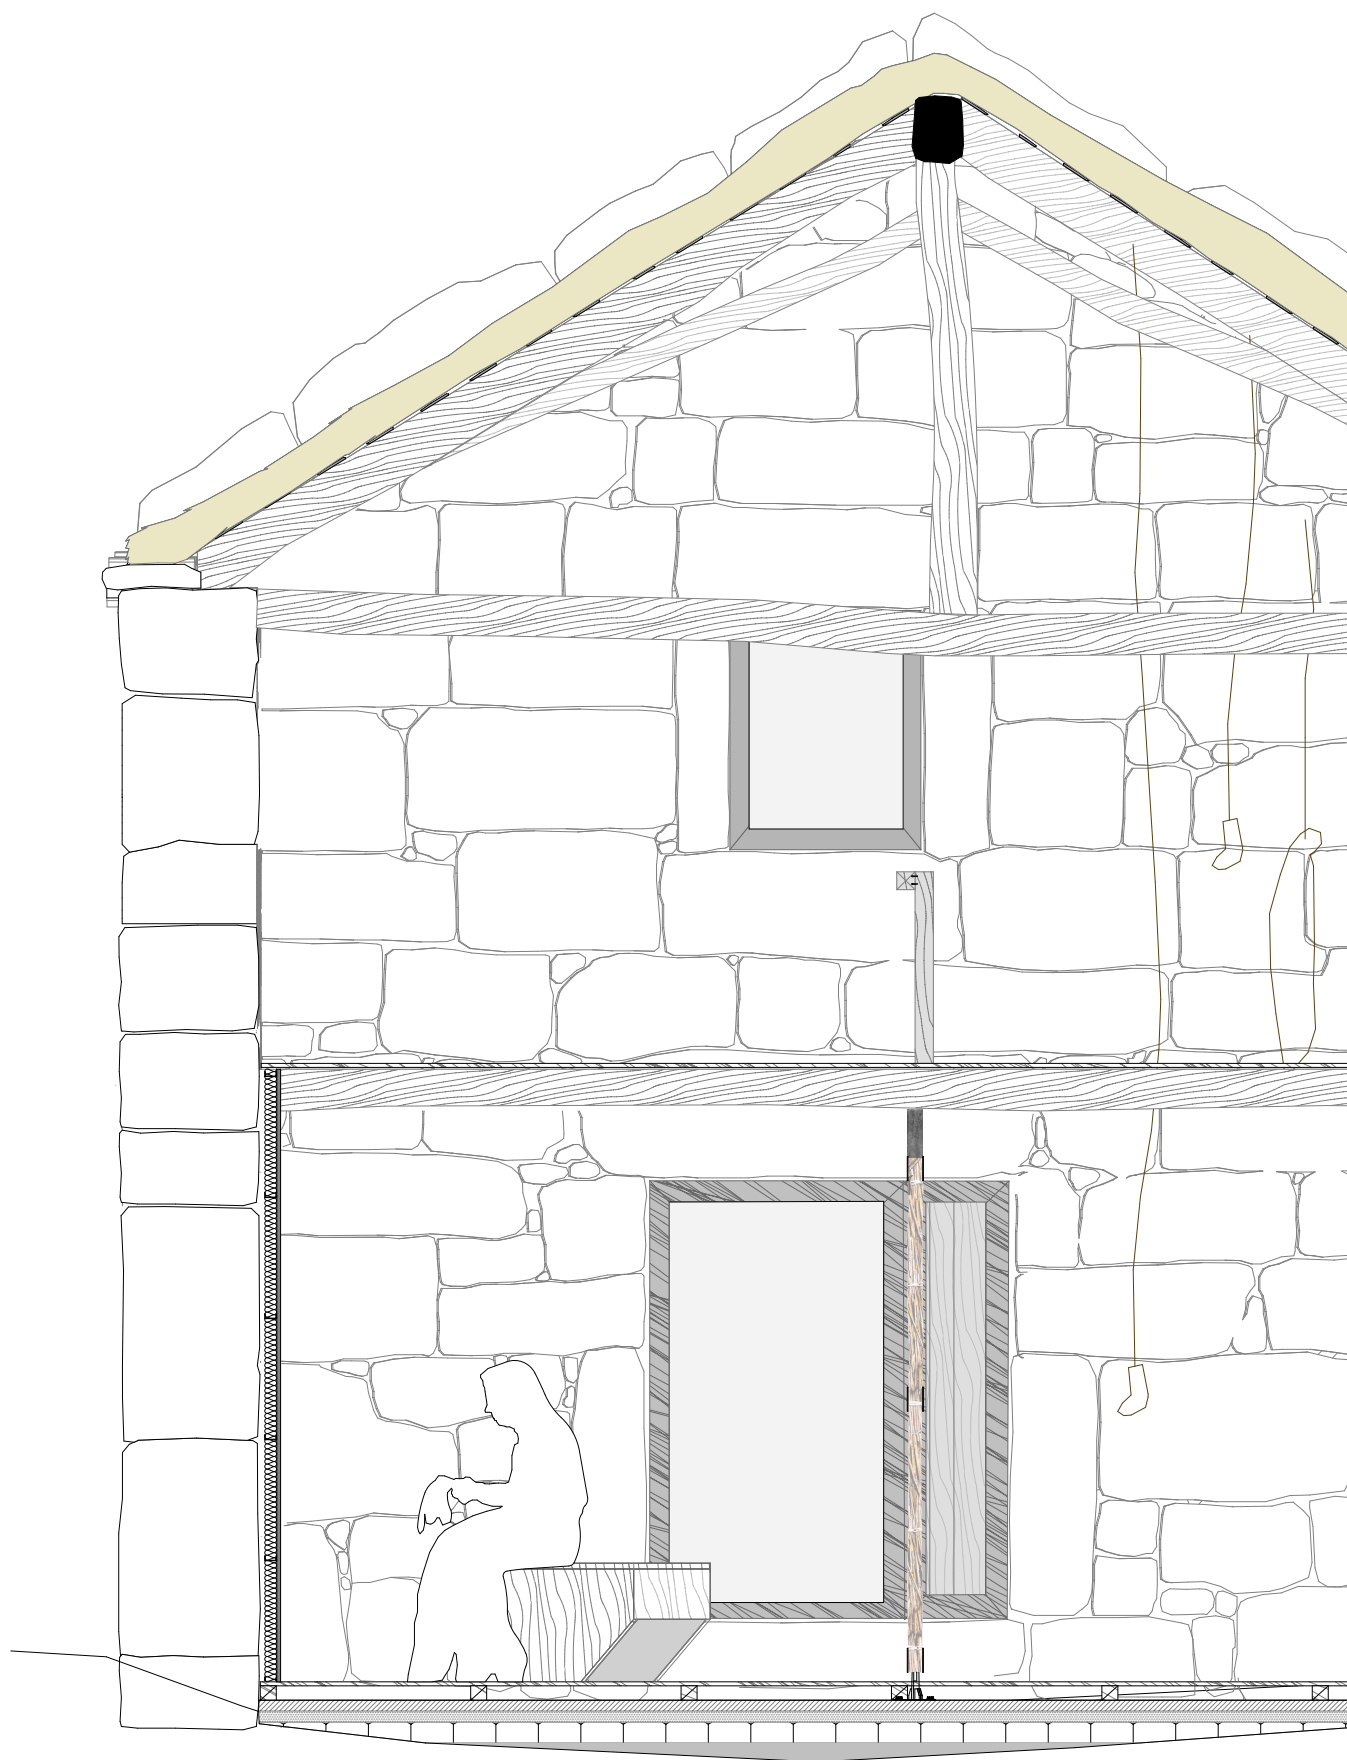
Corte transversal- dois espaços. Pormenores construtivos (Fonte: do autor)
